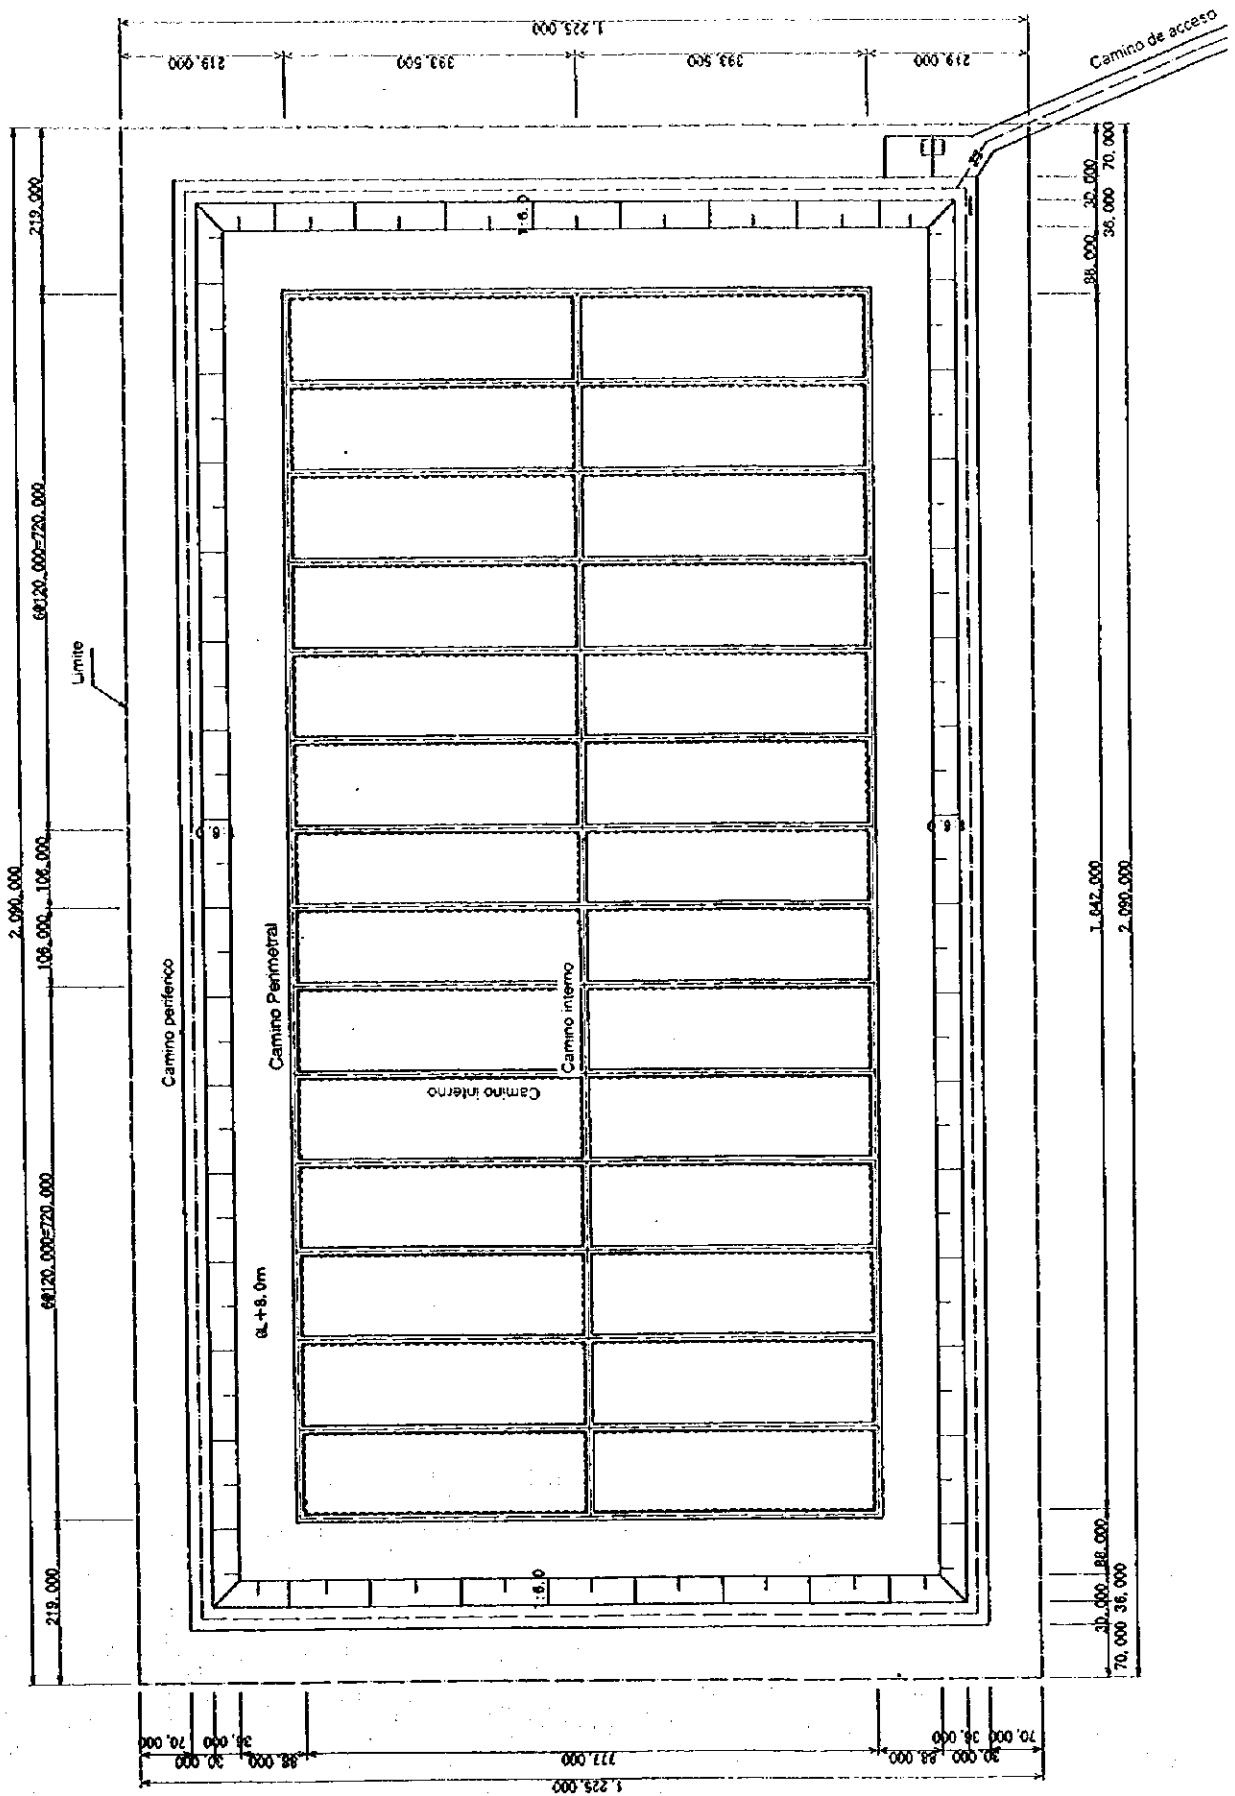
Plano de Planta del Segundo Nivel (8 m. de elevación)
